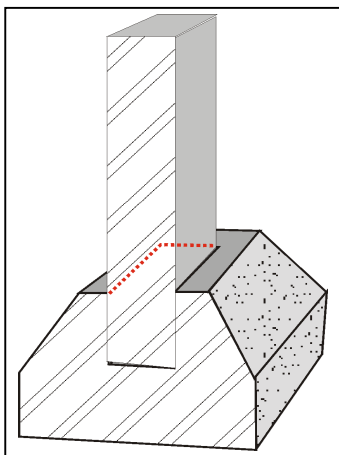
Detalhe da inserção do pilar no elemento de fundação
